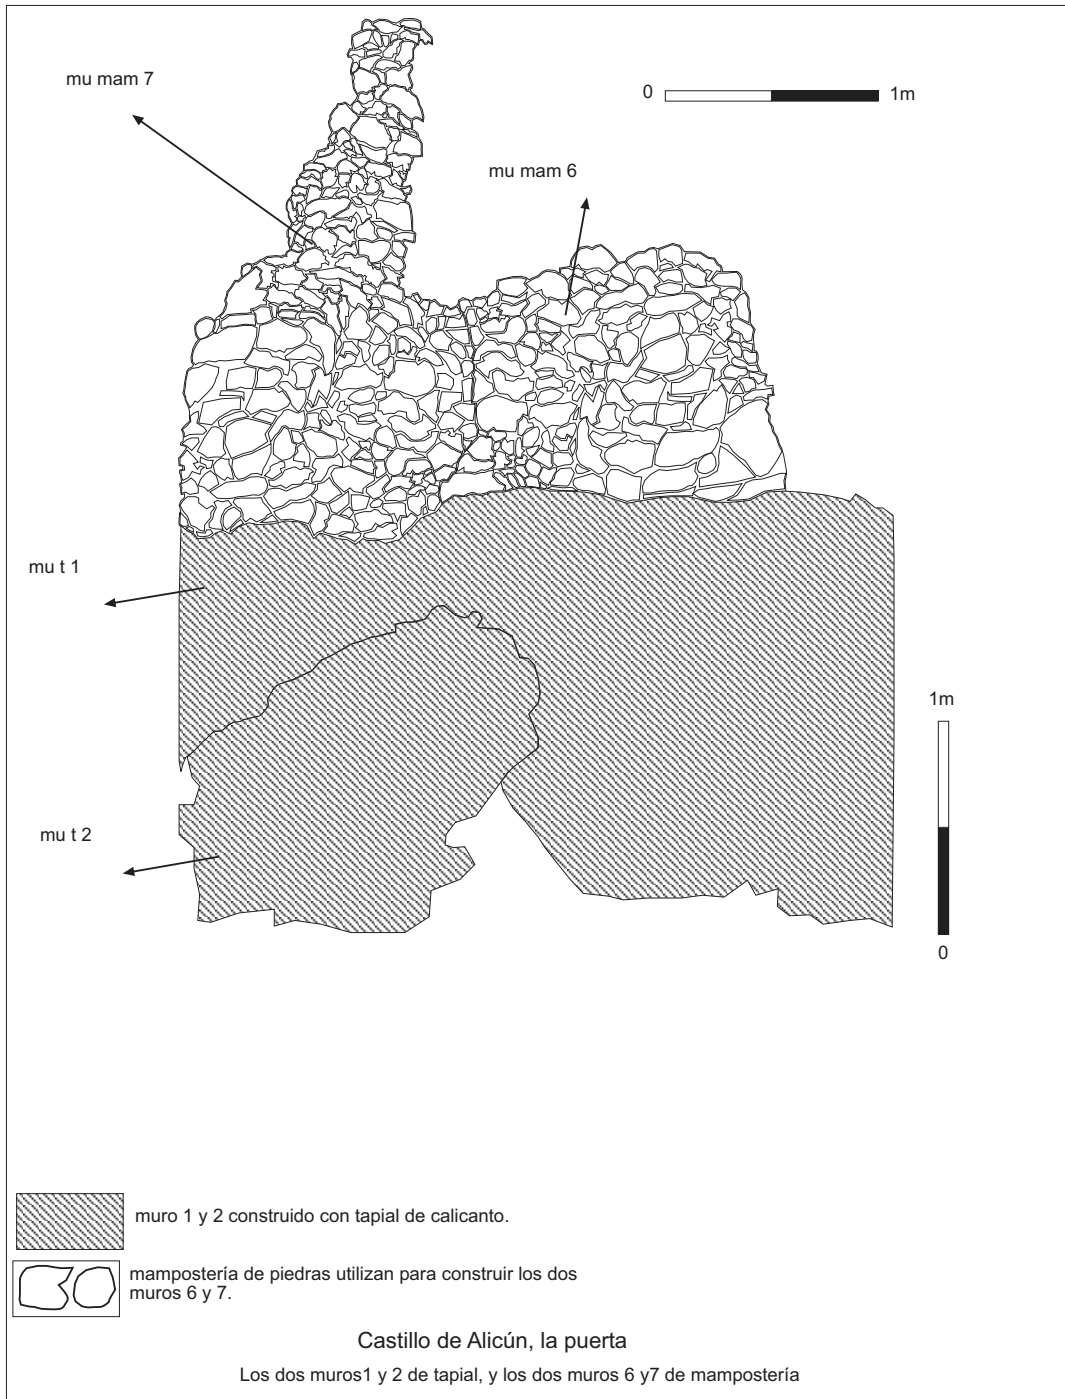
Castillo de Alicún, muro tapial 1 y muro tapial 2 en su cara O. La técnica constructiva, Tapial de calicanto.
